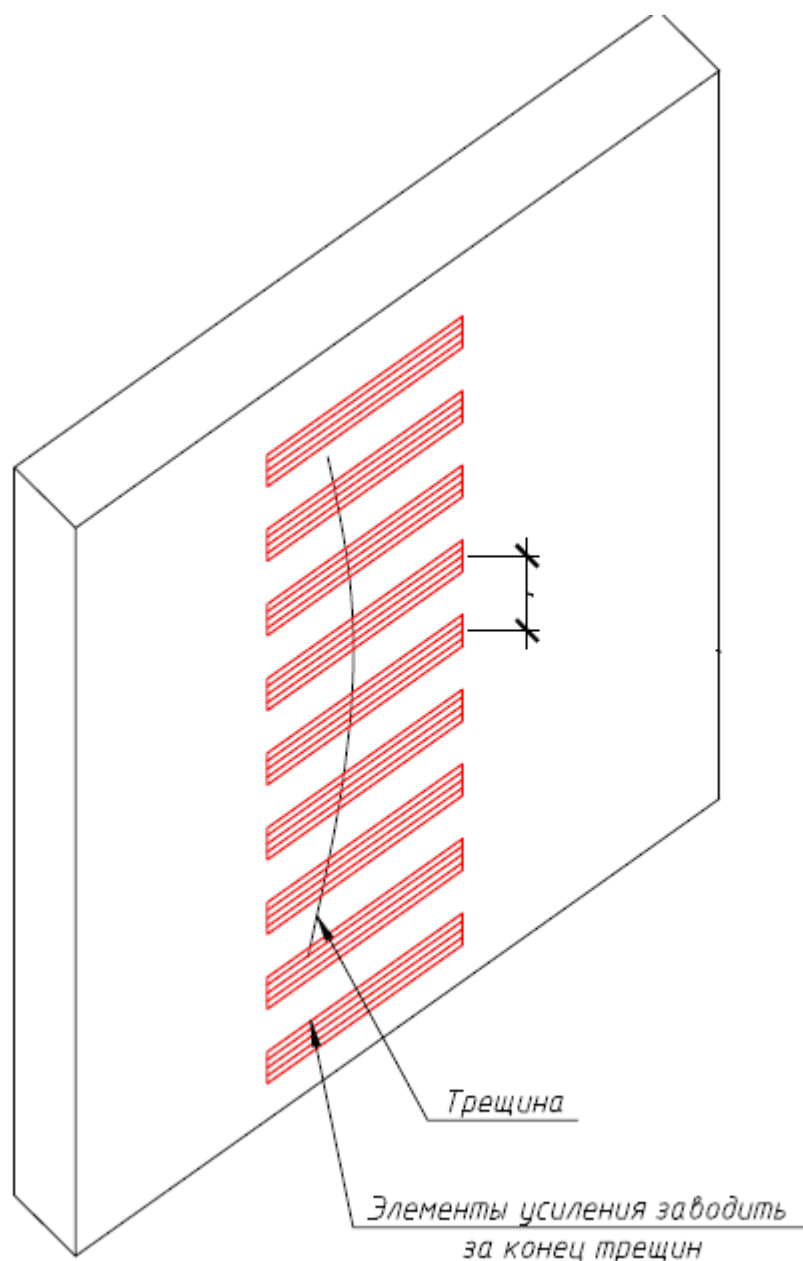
Схема усиления стен с трещинами (ремонт трещины)
